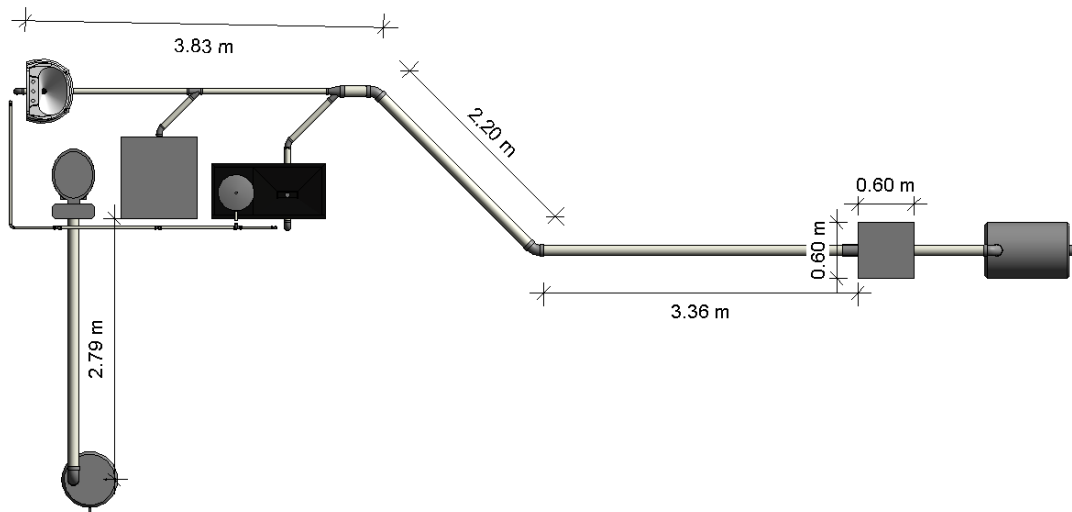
Vista en planta de distribución de desagüe para instalaciones sanitarias de vivienda autosustentable, Elaboración propia (2021)
